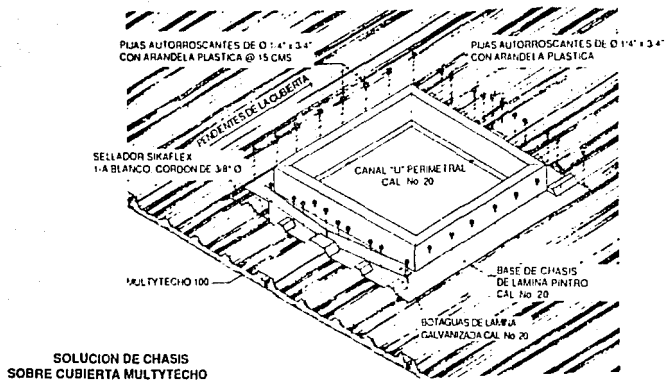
DETALLES CONSTRUCTIVOS DE INSTALACION DEL MULTYTECHO .
